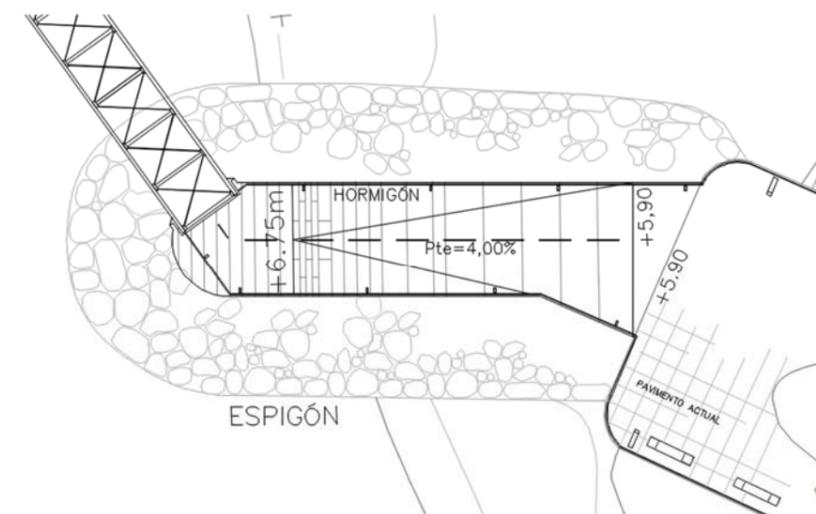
PLANTA DE ESTADO REFORMADO DEL ESPIGÓN
